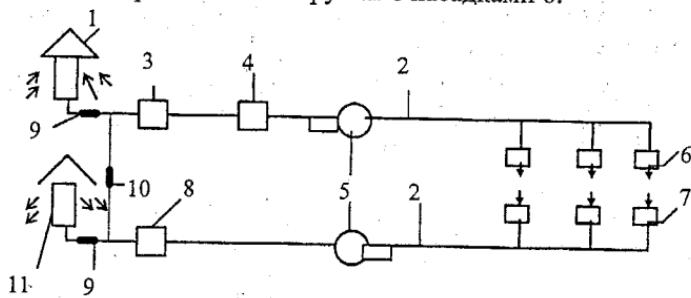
Схема припливно-витяжної механічної вентиляції:
